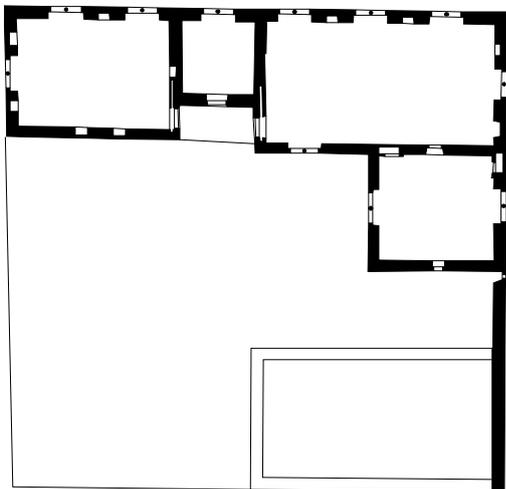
Relevé du plan du château par Patrick Roques (1997) : premier étage.
